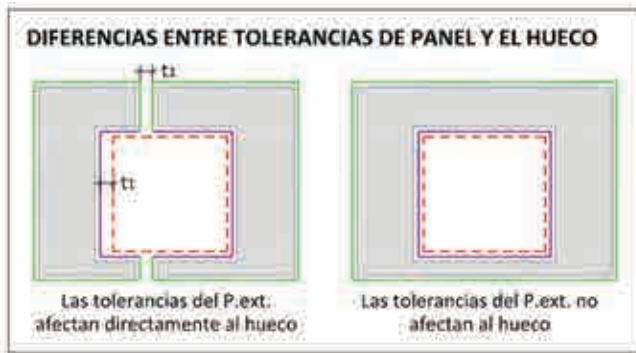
Concentración de las tolerancias al perímetro exterior del componente
